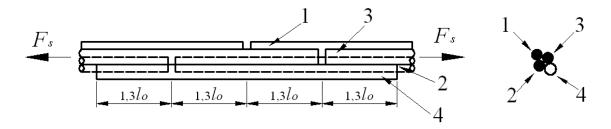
Соединение внахлестку при растяжении с применением четвертого стержня (соединительной накладки)
